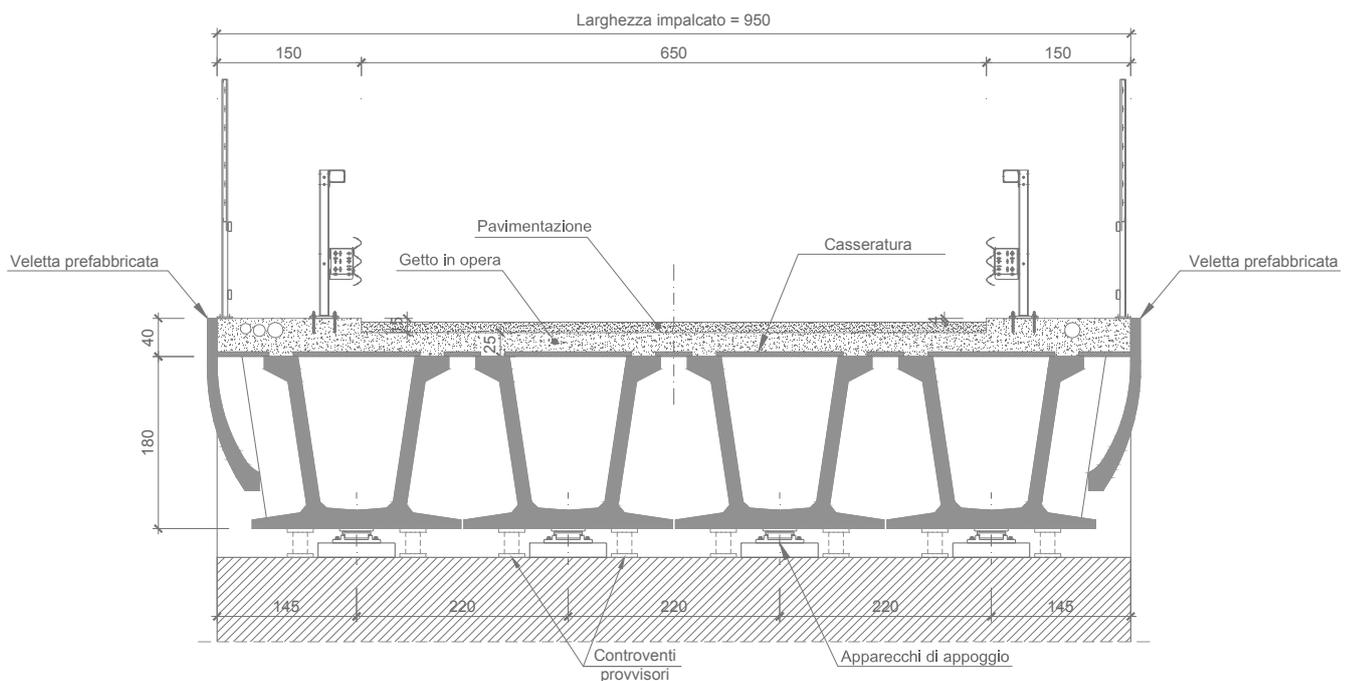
Sezione trasversale impalcato Cavalcavia Strada delle Miliane
